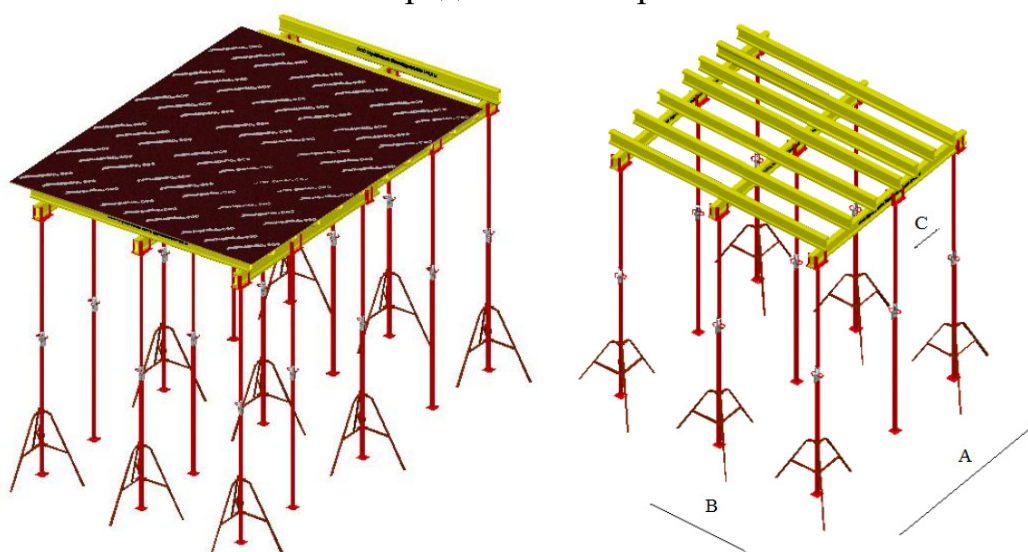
Опалубка перекрытий с использованием телескопических стоек
